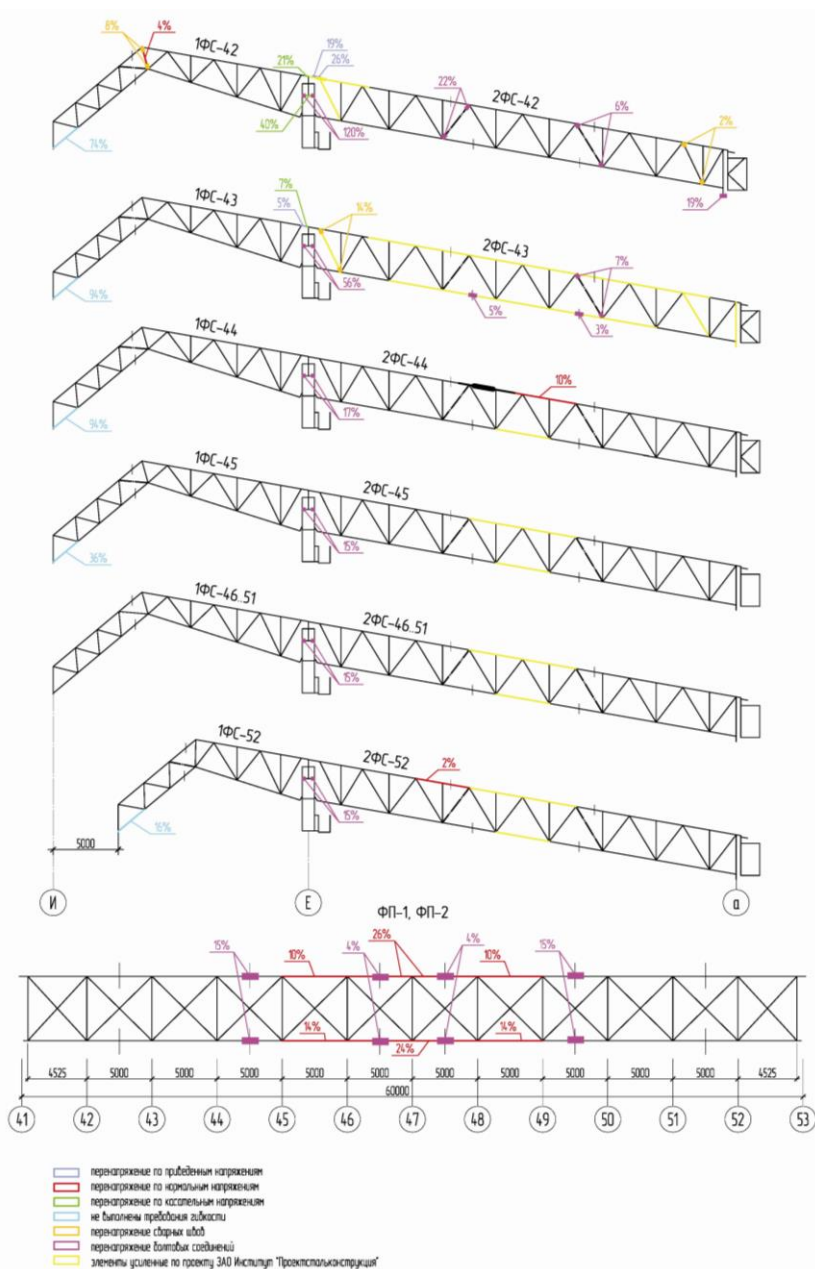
Схемы ферм с указанием элементов и узлов, несущая способность которых не обеспечена от воздействия полных расчетных нагрузок
